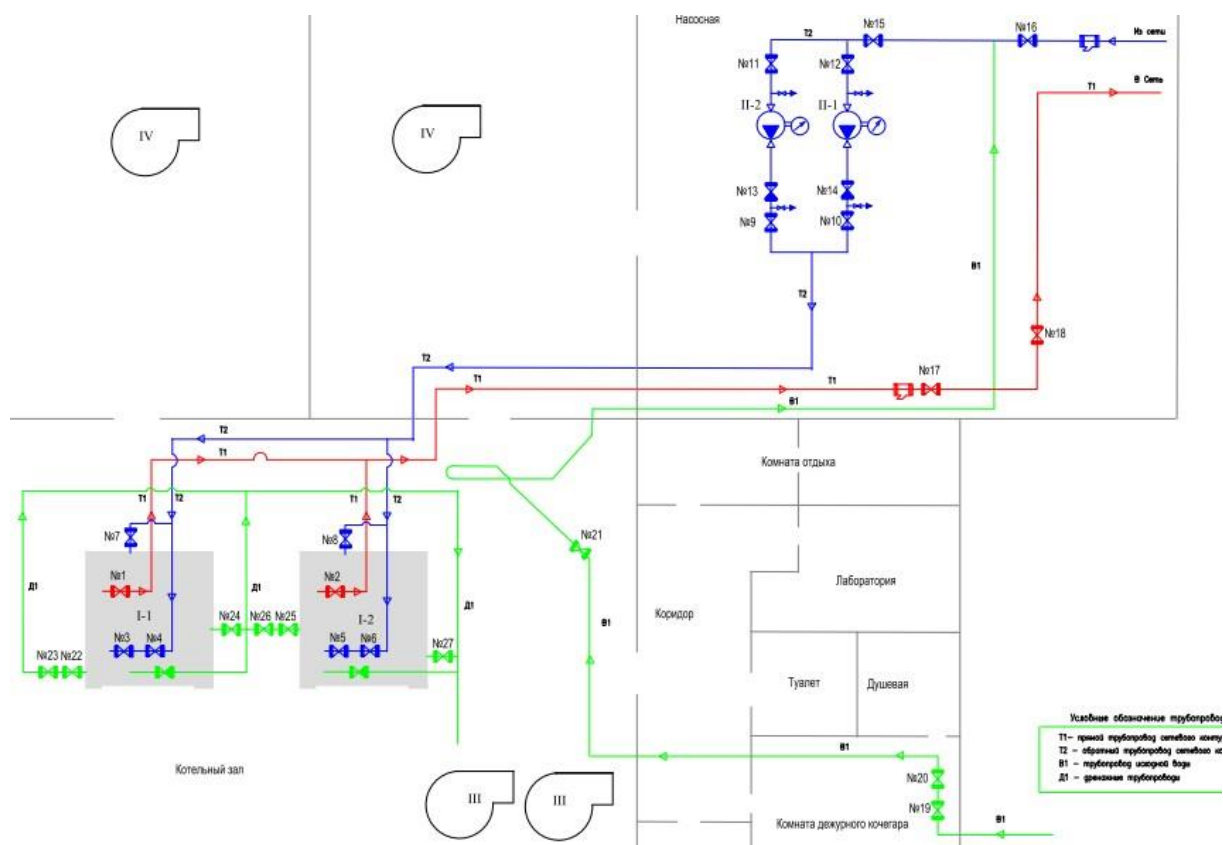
Тепловая схема котельной №7 п. Пижма
